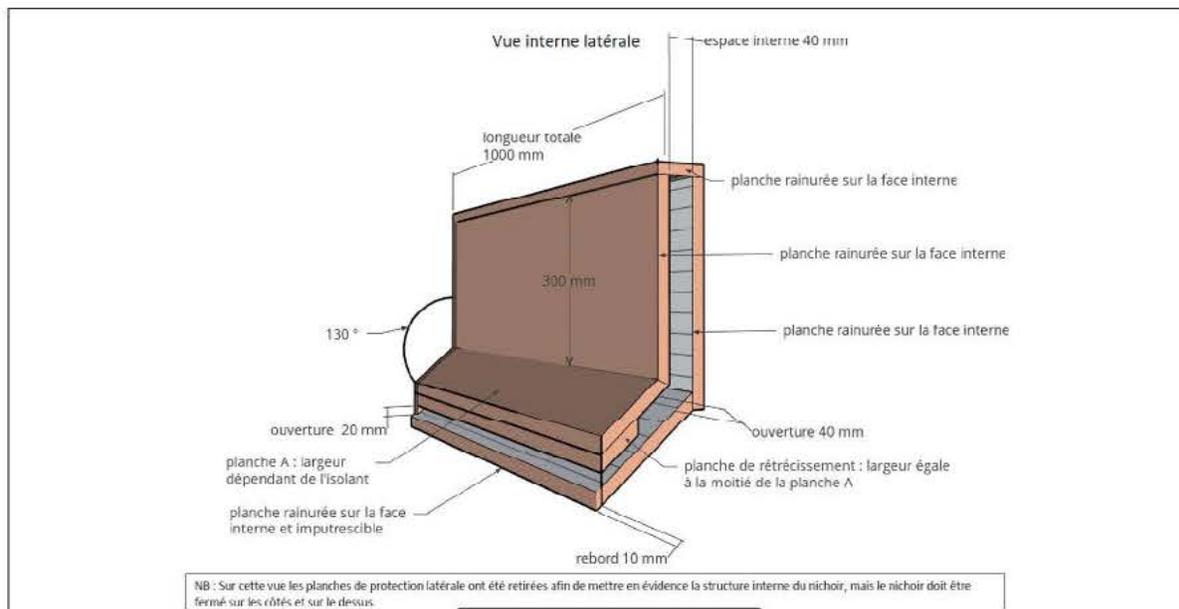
Plan d'un nichoir à placer au cœur de l'ITE
